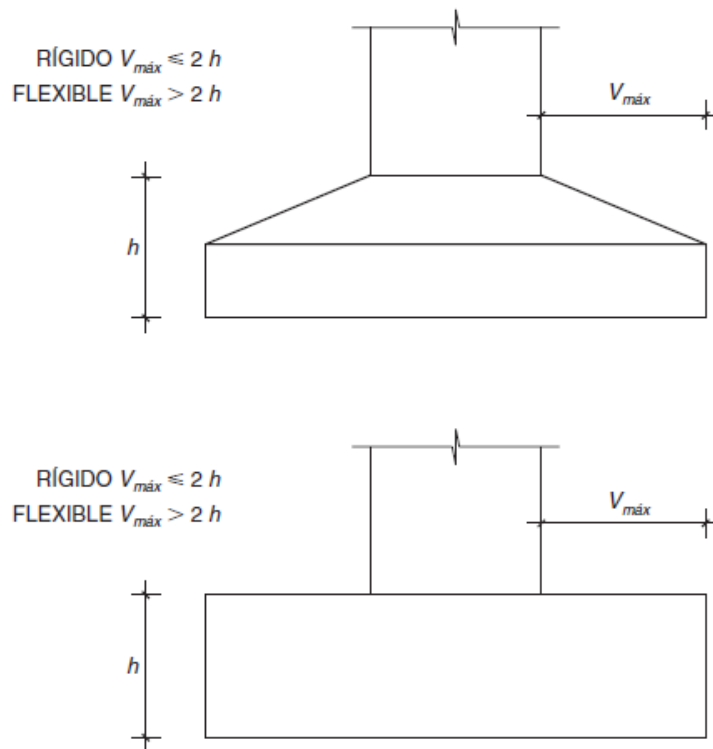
Zapatas rígidas y flexibles. Fuente: EHE-08.
